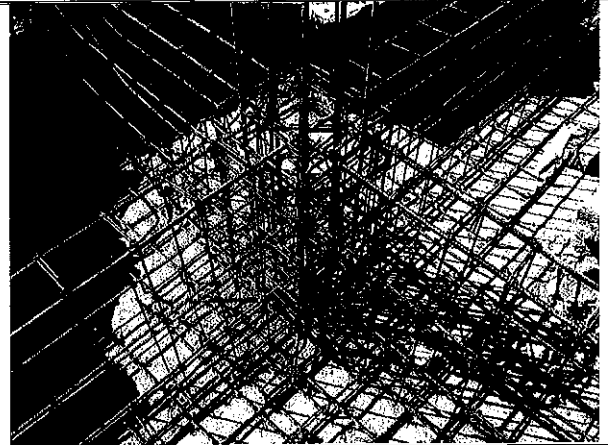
Colado de Cimentación de Viviendas de Enfrente
